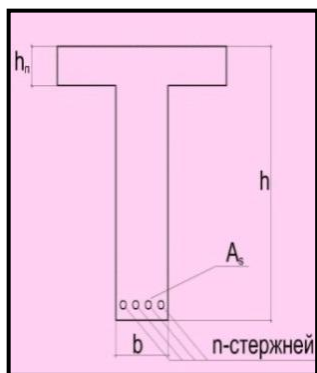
Поперечное сечение железобетонной балки, армированной несколькими стержнями
